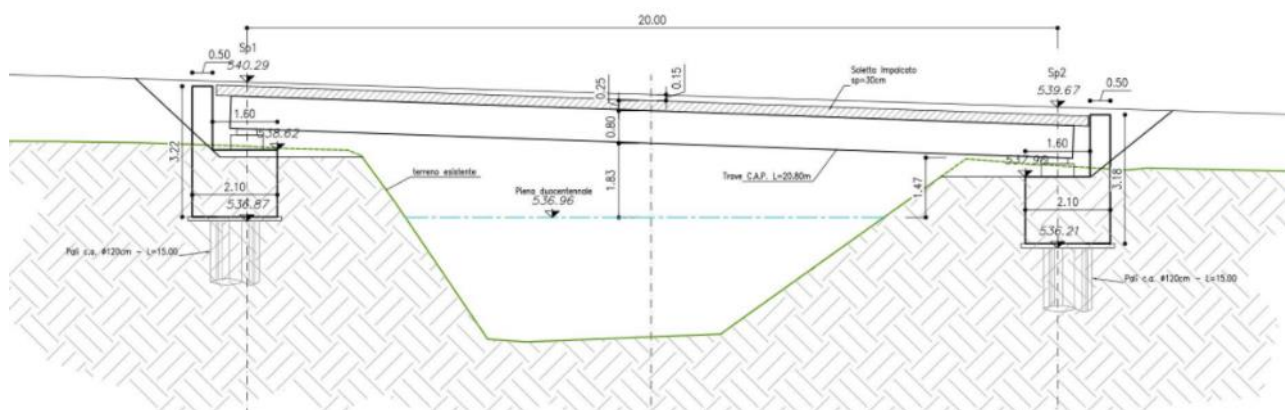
Profilo longitudinale del ponte sul torrente Funes di PE
